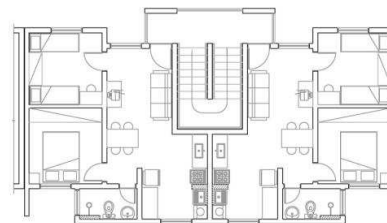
Planta de implantação do Residencial Jardim das Torres.
